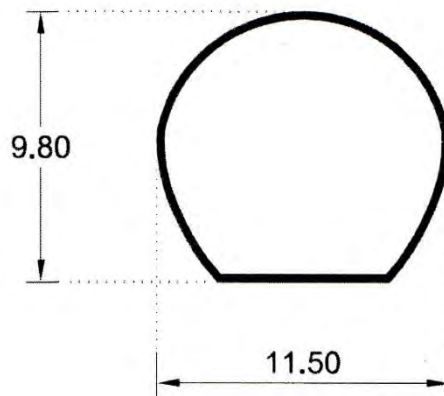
Sección transversal del Túnel de Línea 7.
